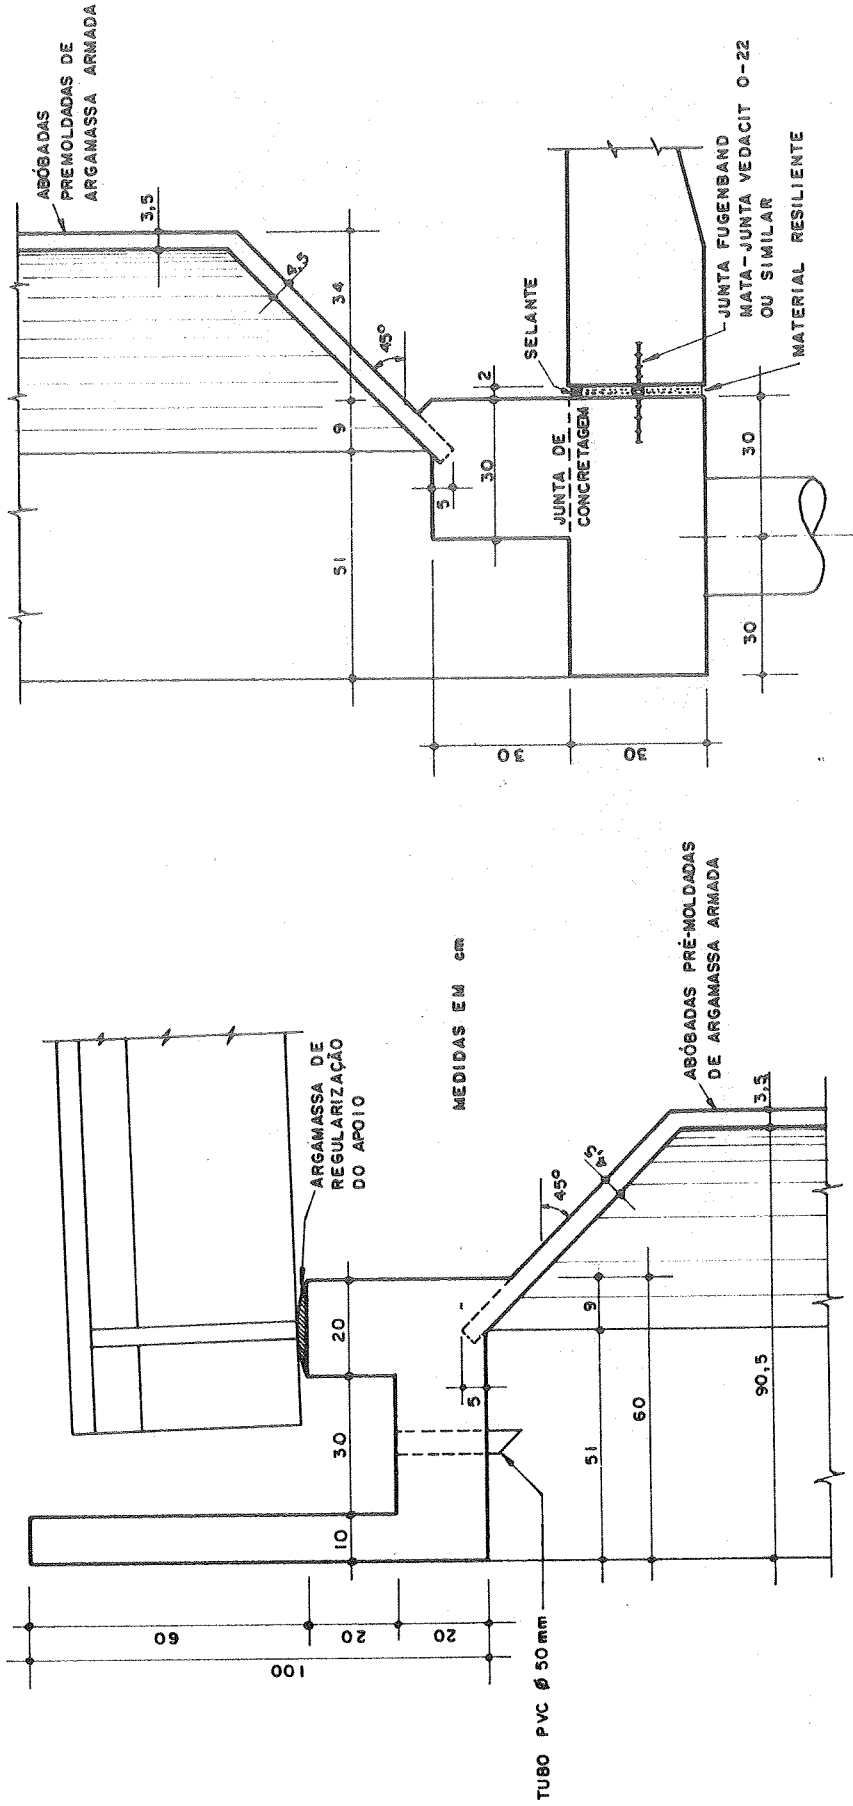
JUNÇÃO DAS ABÓBADAS E DETALHE DAS VIGAS VERTICAIS
